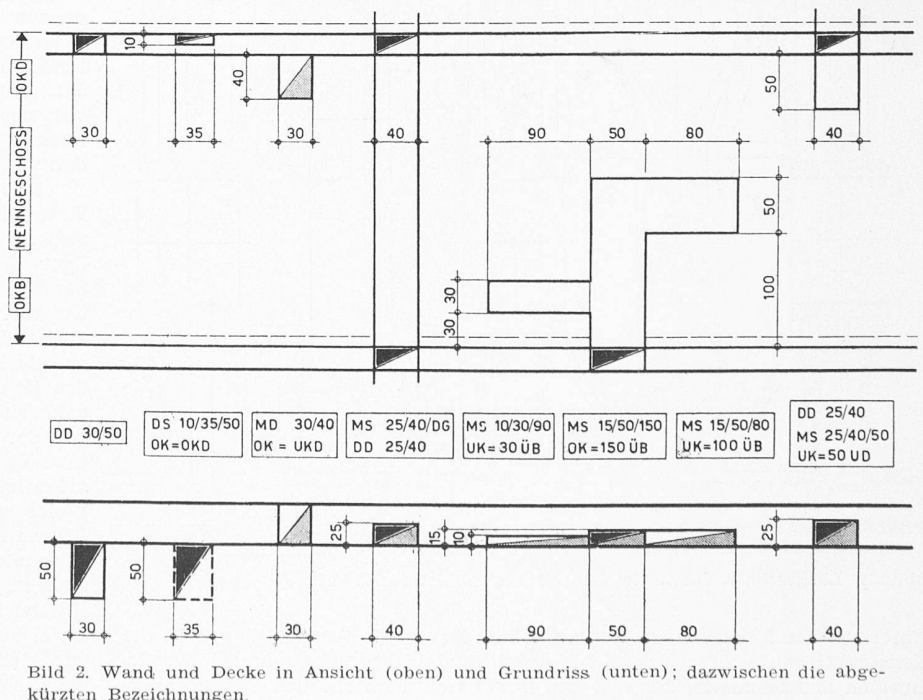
Wand und Decke in Ansicht (oben) und Grundriss (unten); dazwischen die abgekürzten Bezeichnungen.
